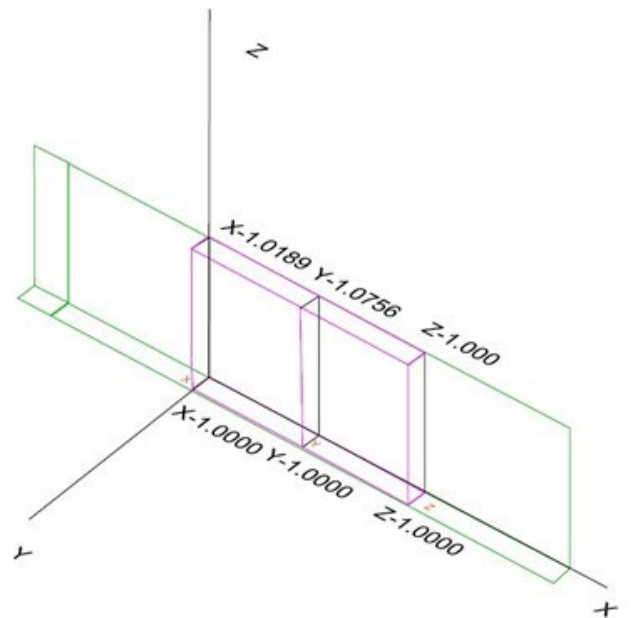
Croquis del desplazamiento del muro de la fachada a una altura de 25.275 m.
